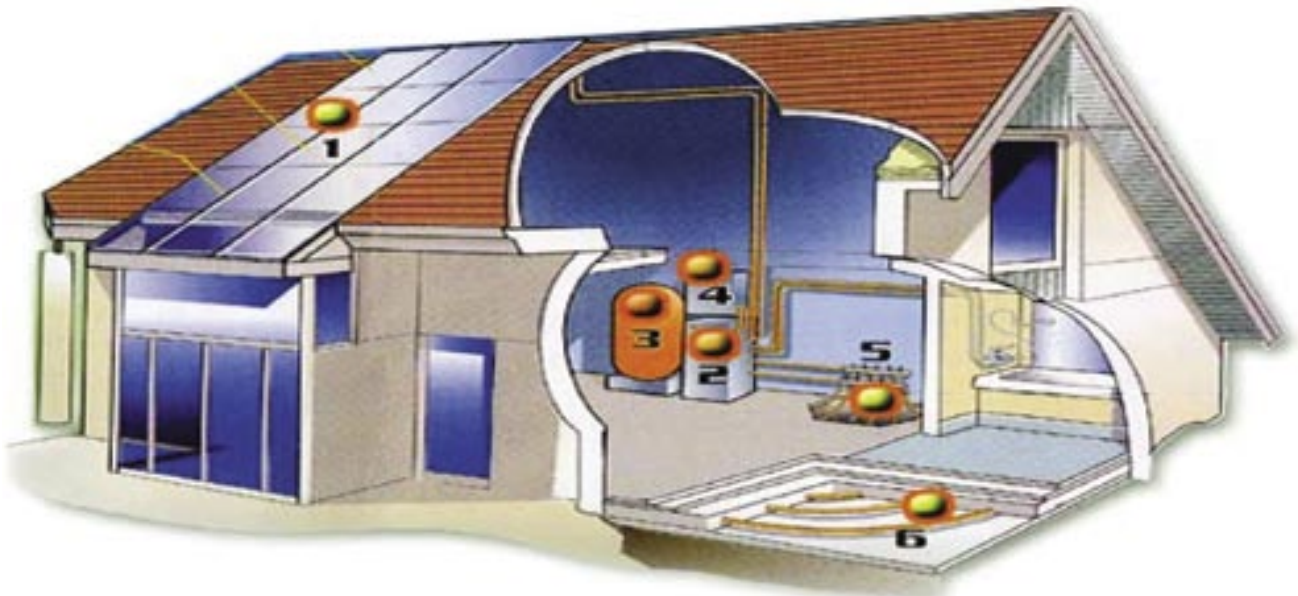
Schéma de principe d'une maison chauffée par un plancher solaire direct
